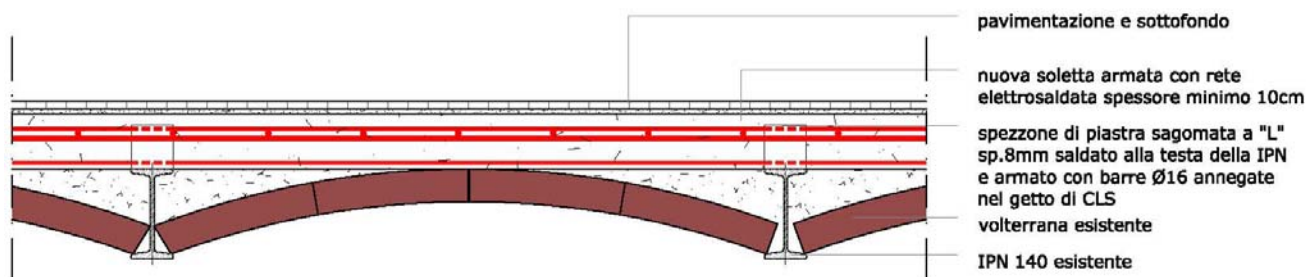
Sezione trasversale di un solaio del piano terra allo stato di progetto.
